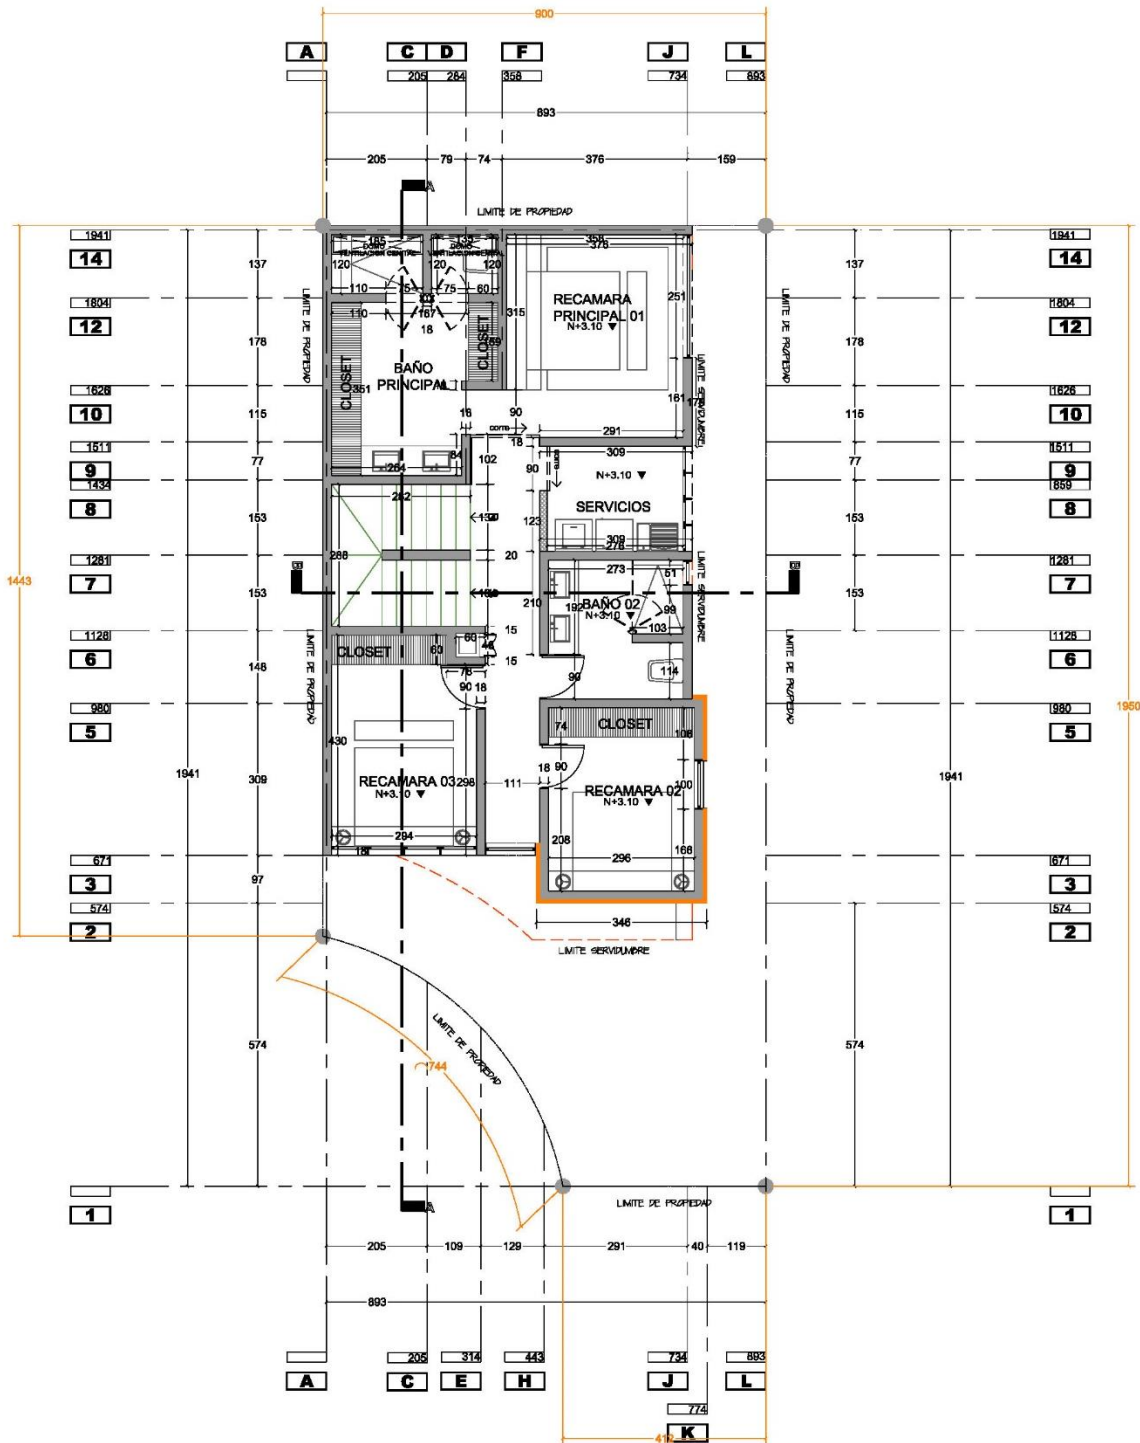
Planta alta casa MO estado actual, elaboración propia (2020)
